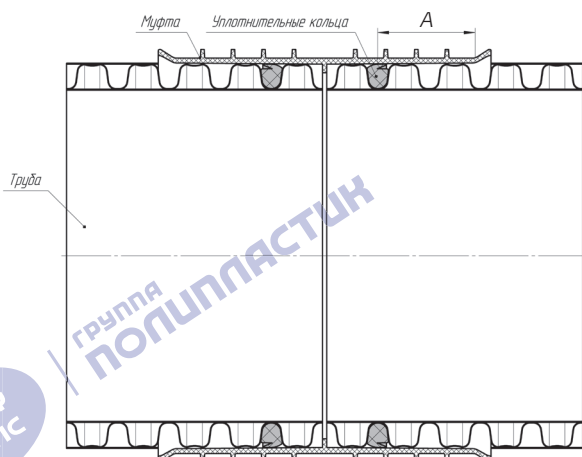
Схема соединения труб муфтой с уплотнительными кольцами
